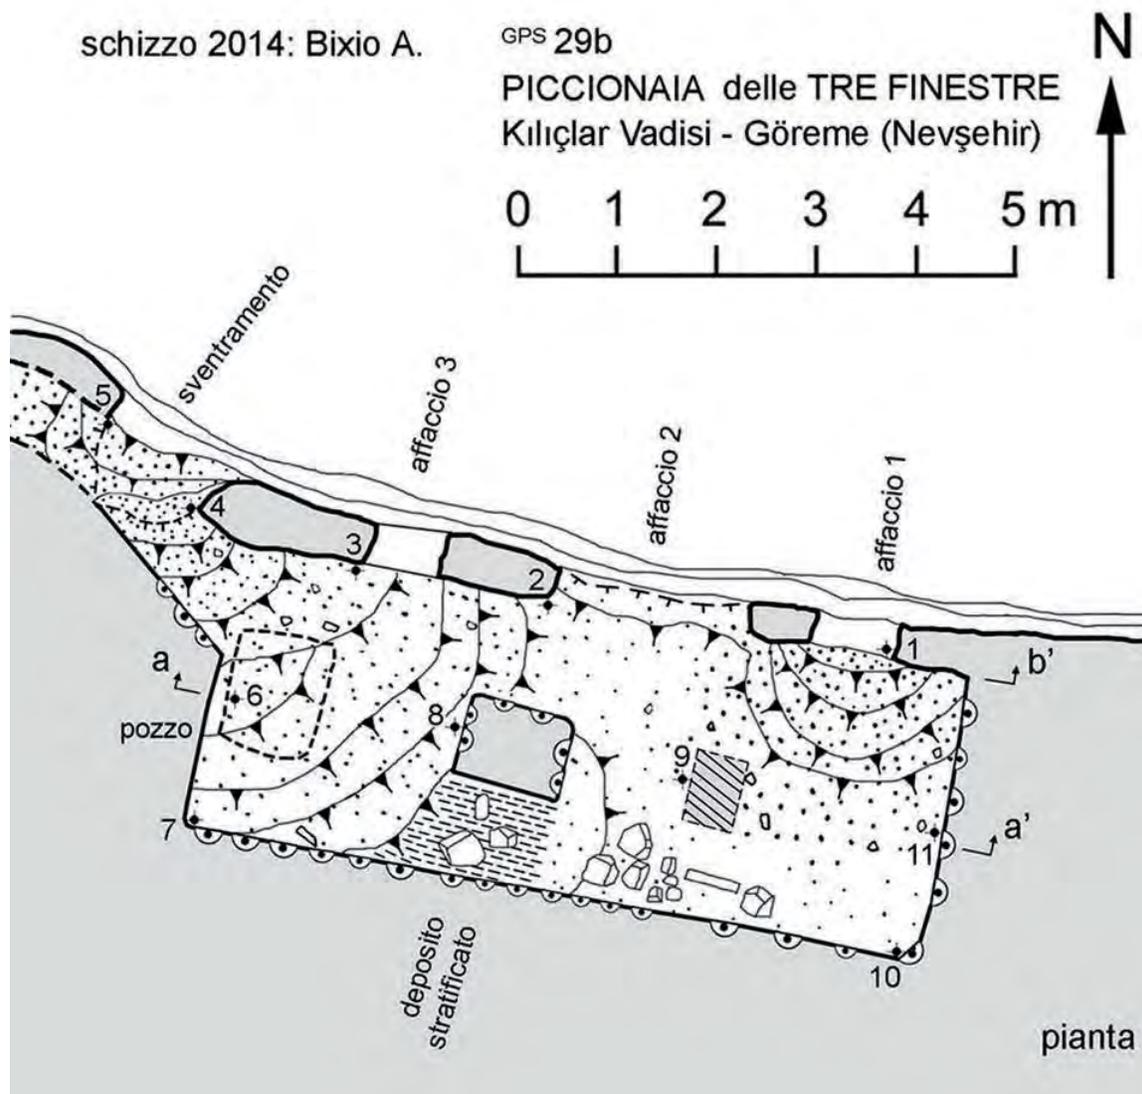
Piccionaia delle Tre Finestre (grafica A. Bixio).
